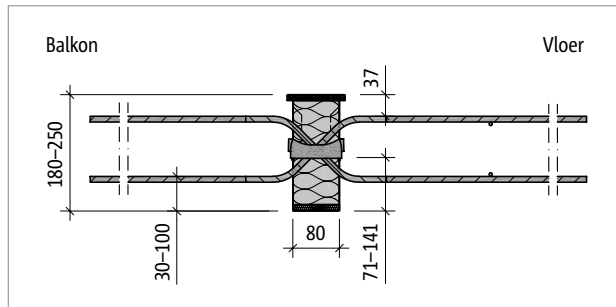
Schöck Isokorb® T type Q-E-V7-L250: Bovenaanzicht
